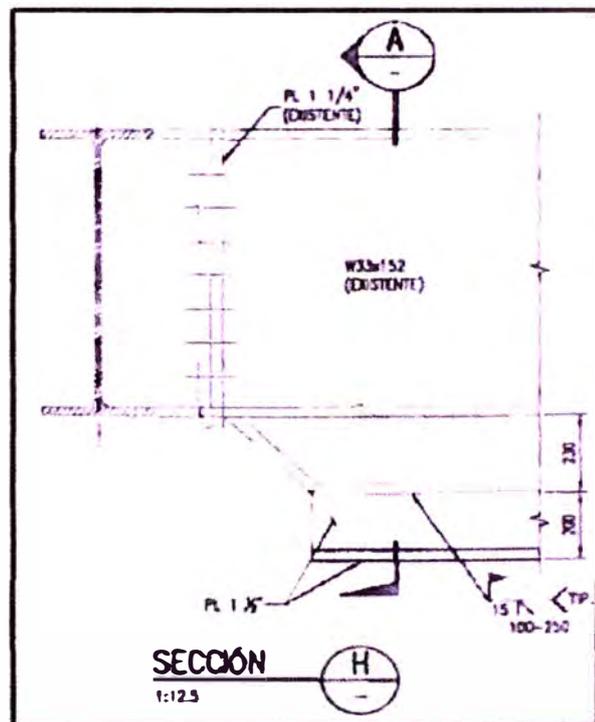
Detalle lateral de reforzamiento de viga V-1
